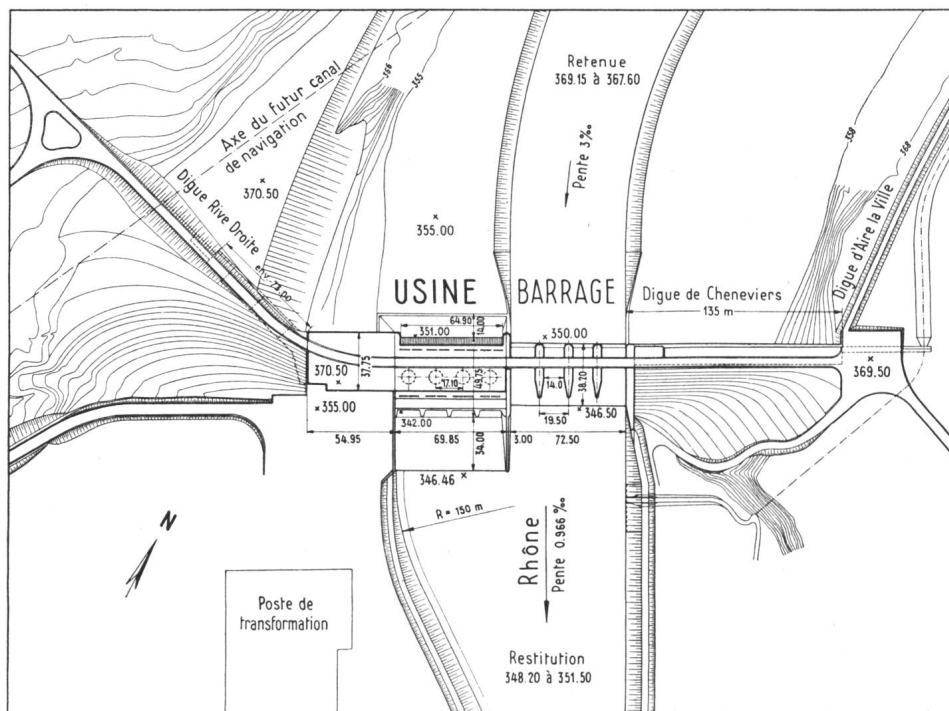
Plan de l'usine et du barrage. Echelle 1 : 5000.
